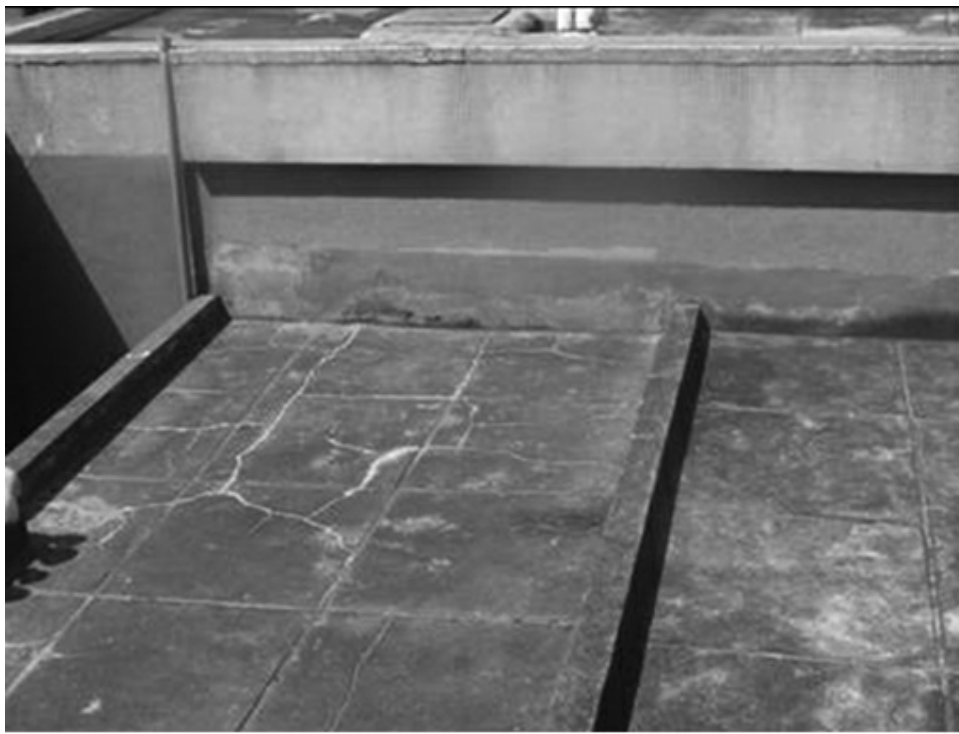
Cobertura do telhado apresentando regiões com fissuras no piso e deficiência do sistema de impermeabilização.
